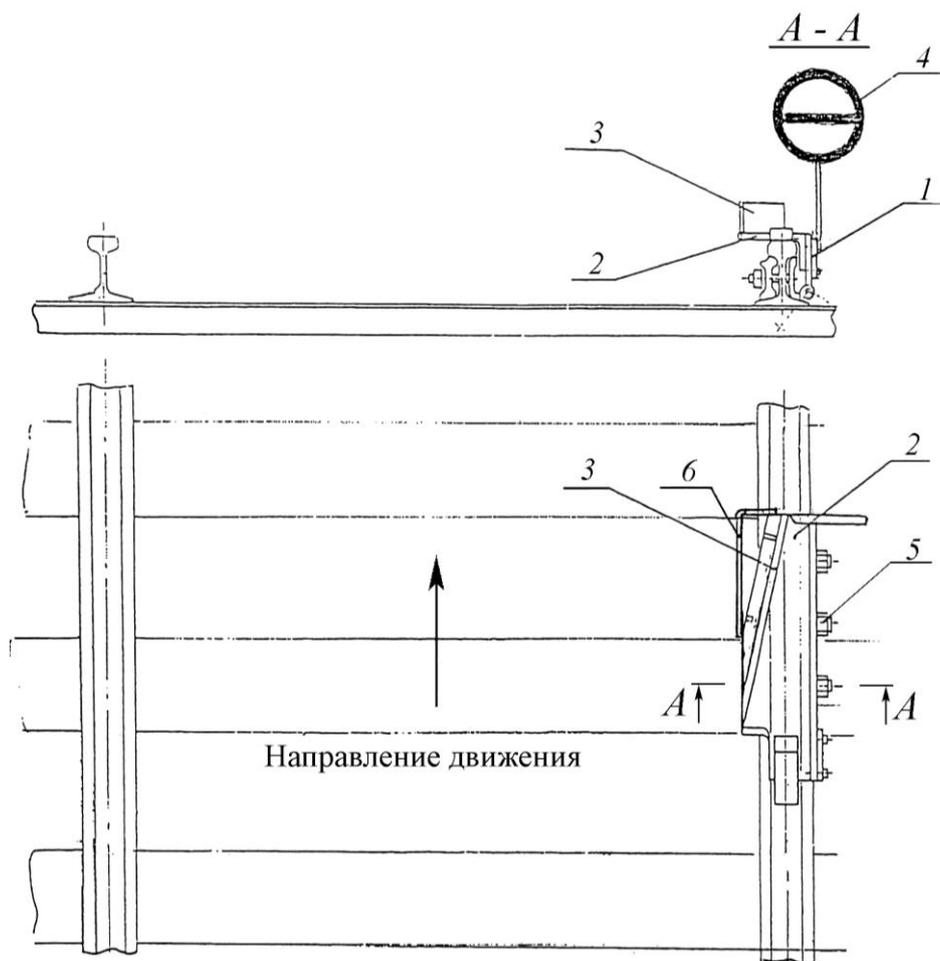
Конструкция колесосбрасывающего башмака КСБ-Р
